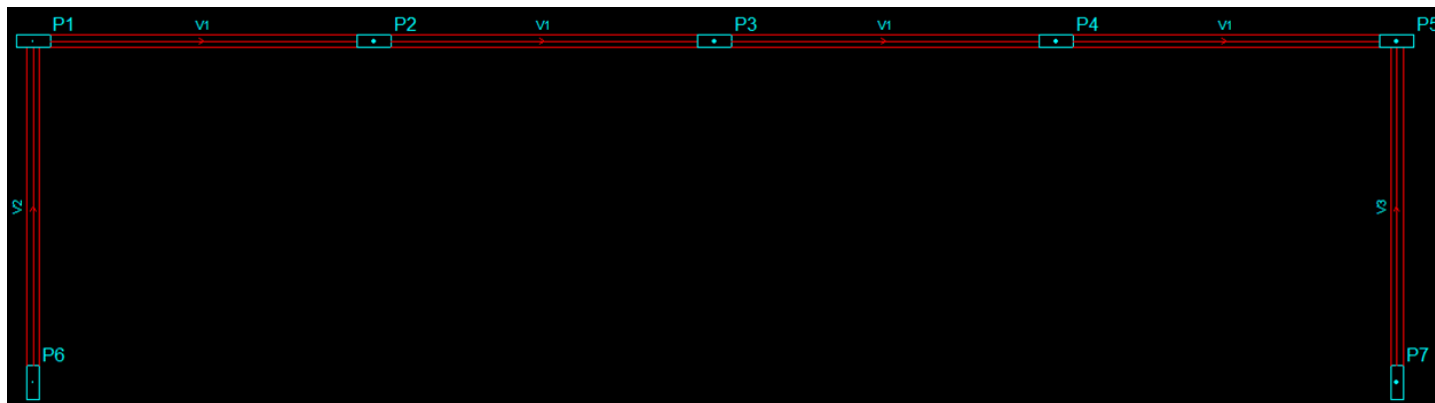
Lançamento da estrutura no pavimento “ Tipo ”
